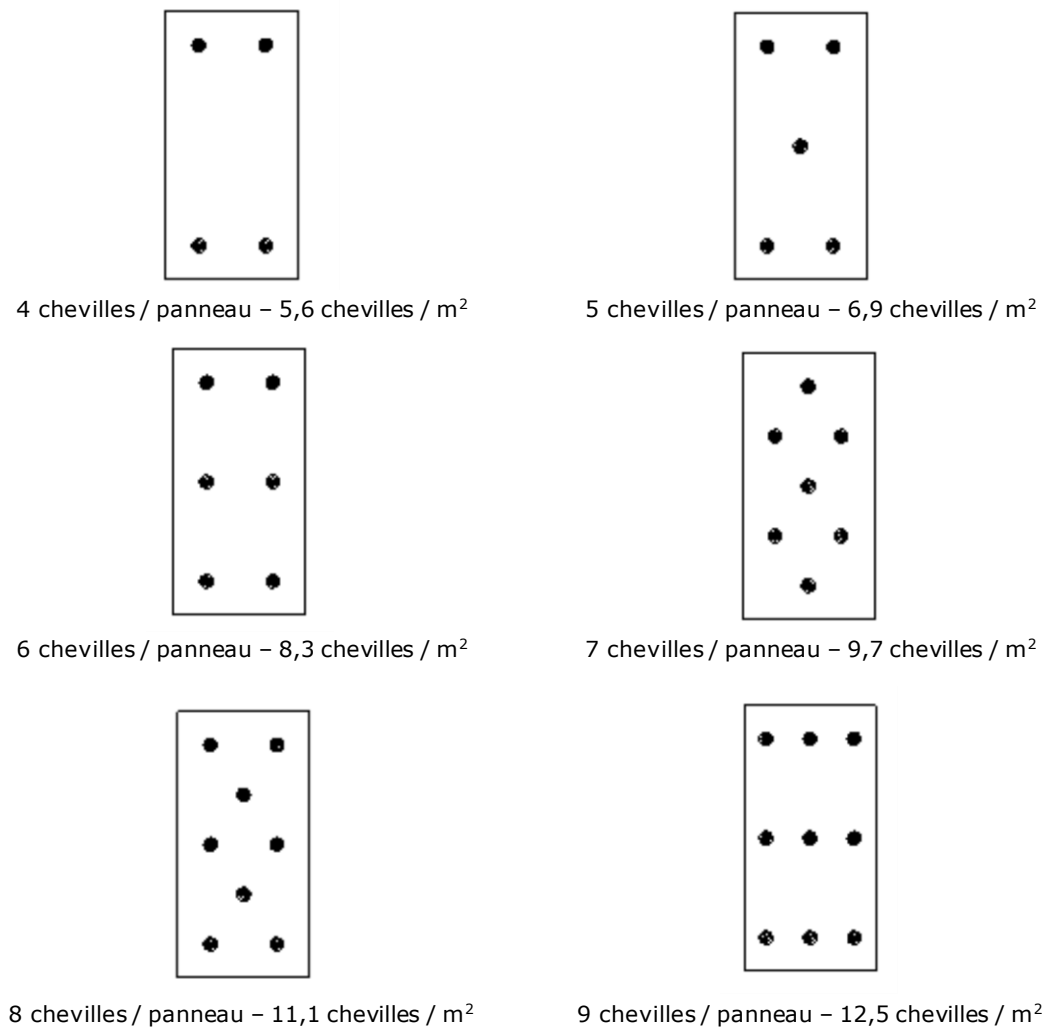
Panneaux ECOROCK MONO, ECOROCK DUO, ISOVER TF 36, et FKD-MAX C2 de dimensions 1200 x 600 mm - plans de chevillage « en plein » en pose verticale (espacement entre chevilles ≥ 150 mm)
